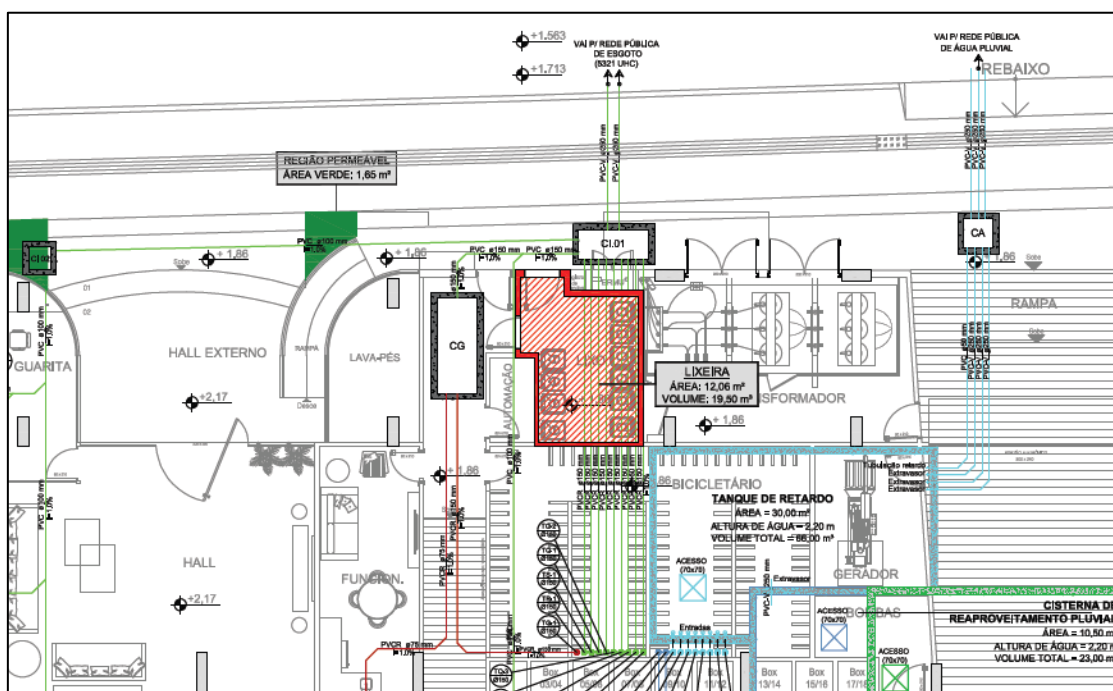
Localização da lixeira do empreendimento (destaque vermelho). Fonte Projeto Hidrossanitário.
